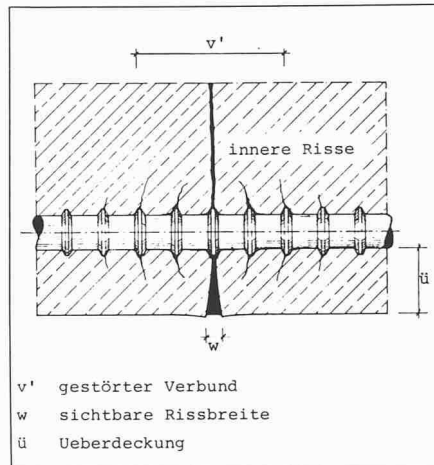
Rissebildung im Stahlbeton (nach GOTO, ACI Journal 68, 1971)
